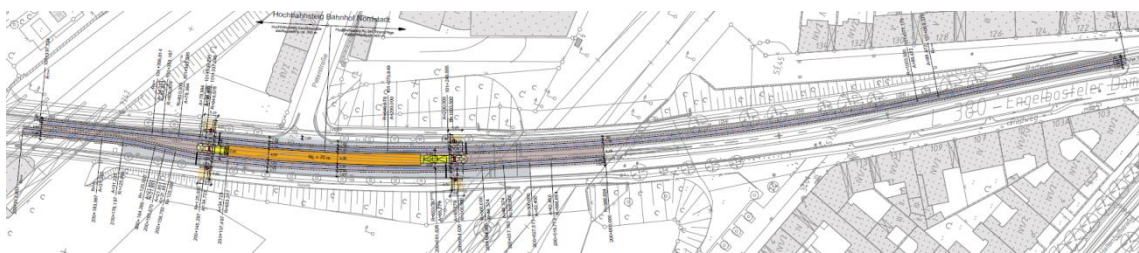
Ausschnitt aus dem Lageplan Variante 1
